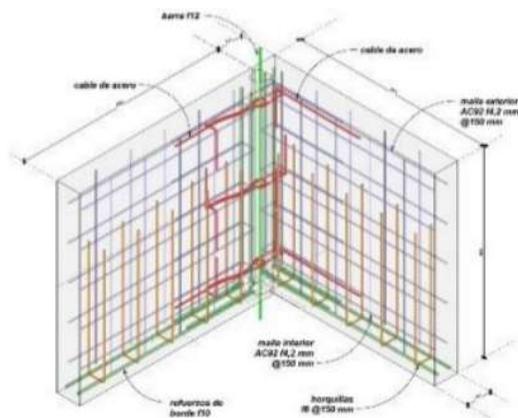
Detalle unión de muros - Fuente ingeniería Baumax-Sirve.
